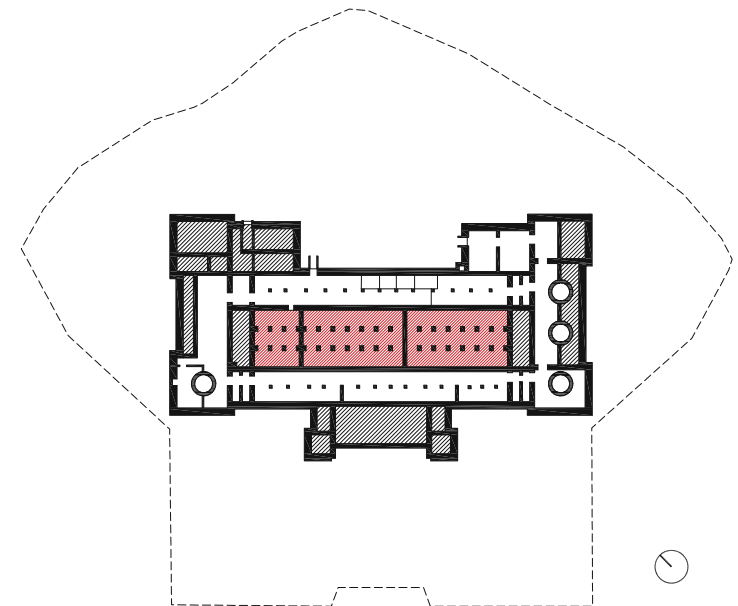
Planausschnitt Grundriss BVA um 1905 | BVA:
